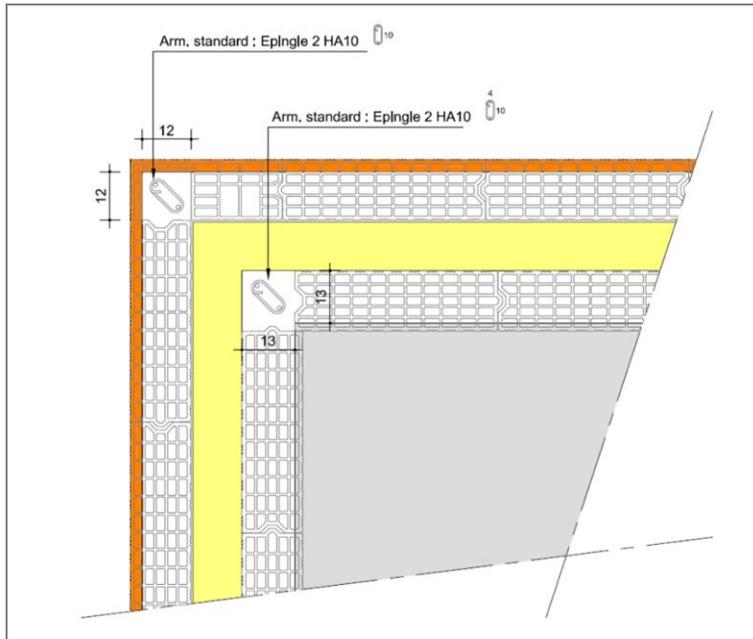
Exemple de liaison des aciers en angle de construction avant coulage du plancher
